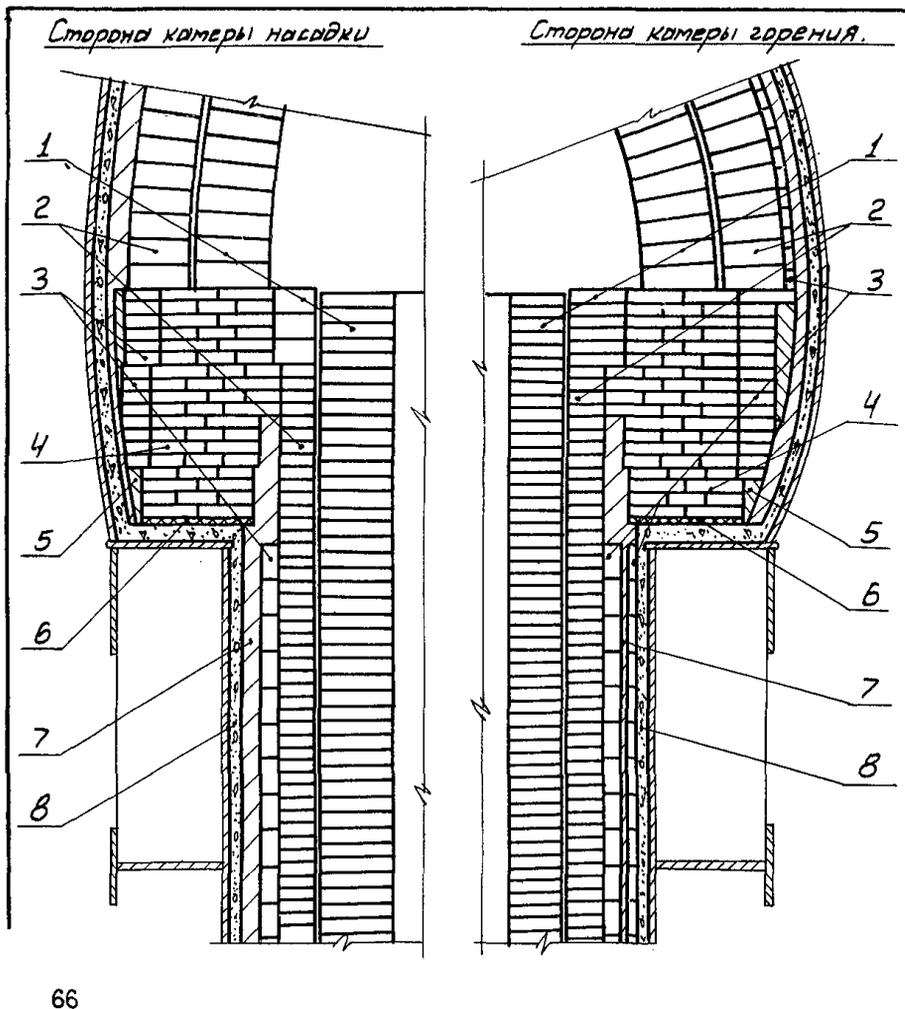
Кладка купола воздухонагревателя с выносной камерой горения:
